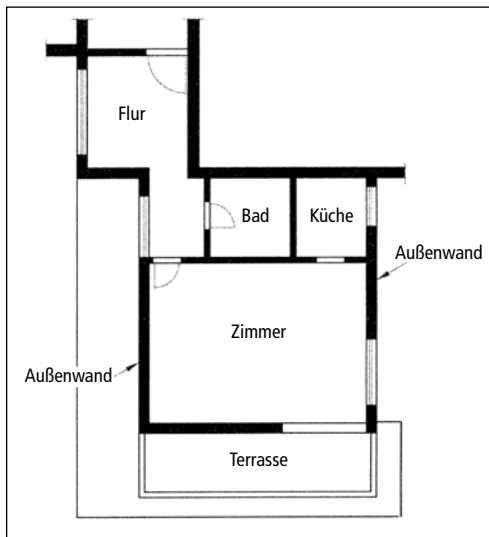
■ Grundriss der Penthouse-Wohnung
